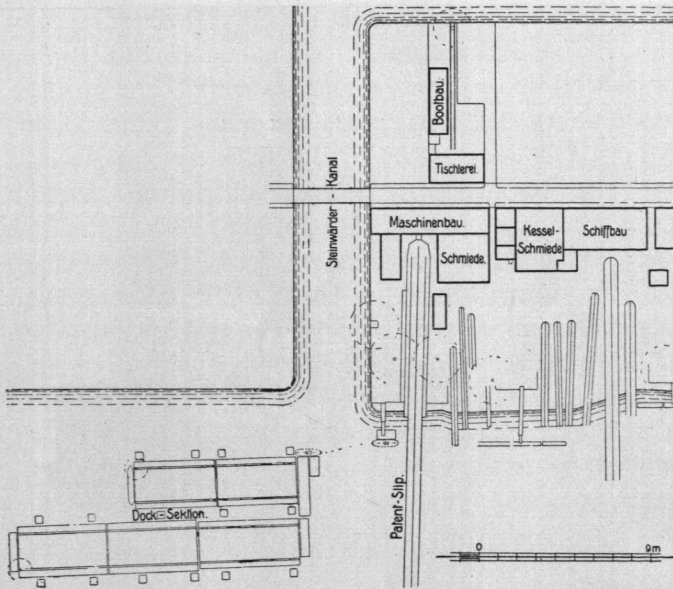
Schiffswerft H. C. Stülcken Sohn, Lageplan.
